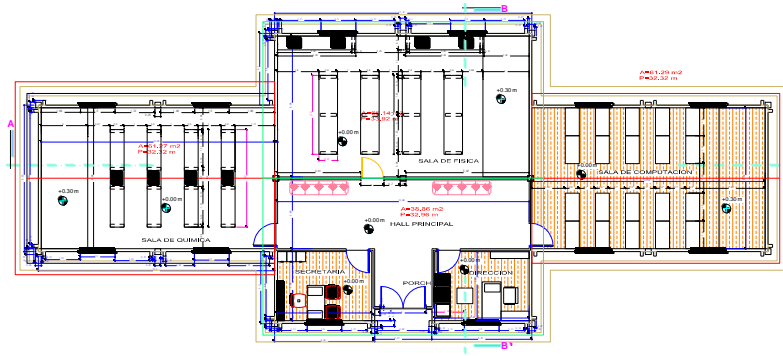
Vista del Plano arquitectónico Planta Alta Aulas
